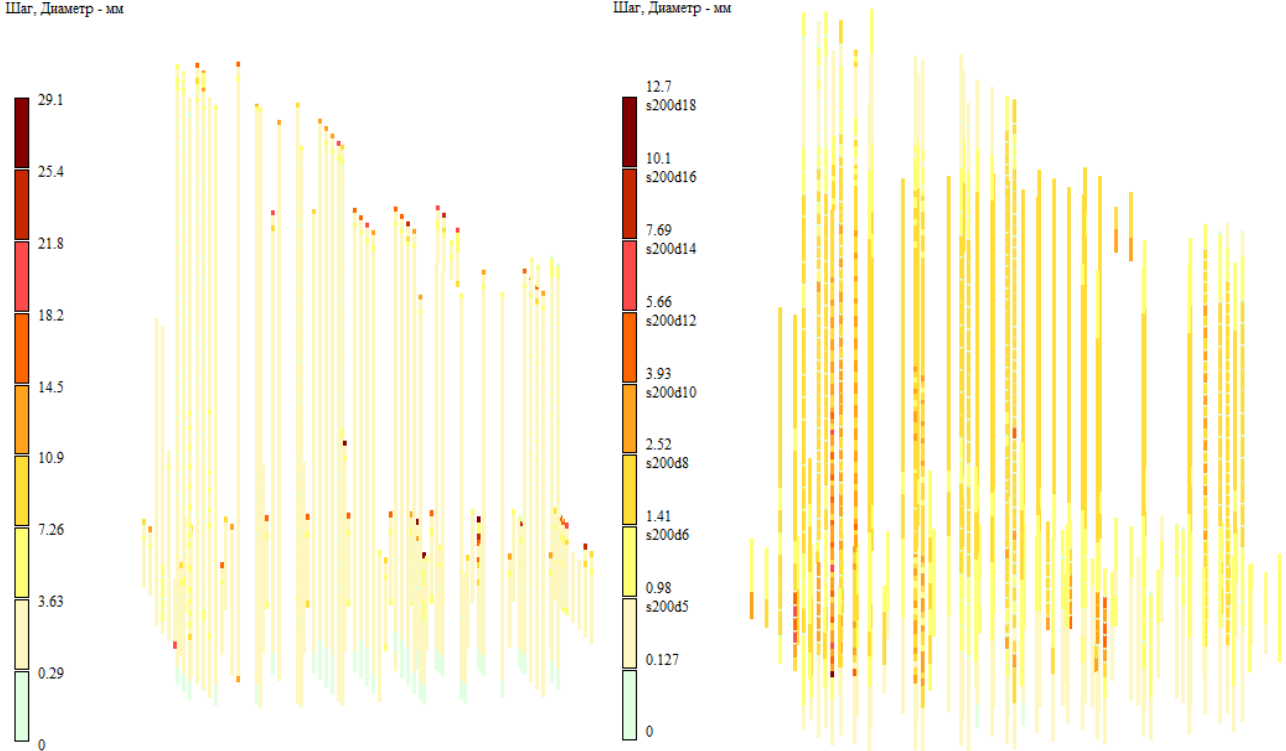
Схема армирования продольной и поперечной арматуры
